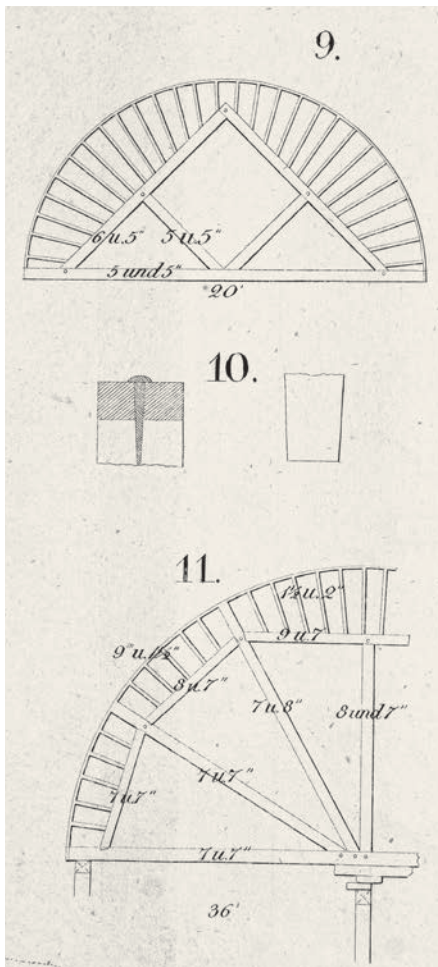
Einfache Lehrbögen für kleinere Öffnungen (Lassaulx 1829)
